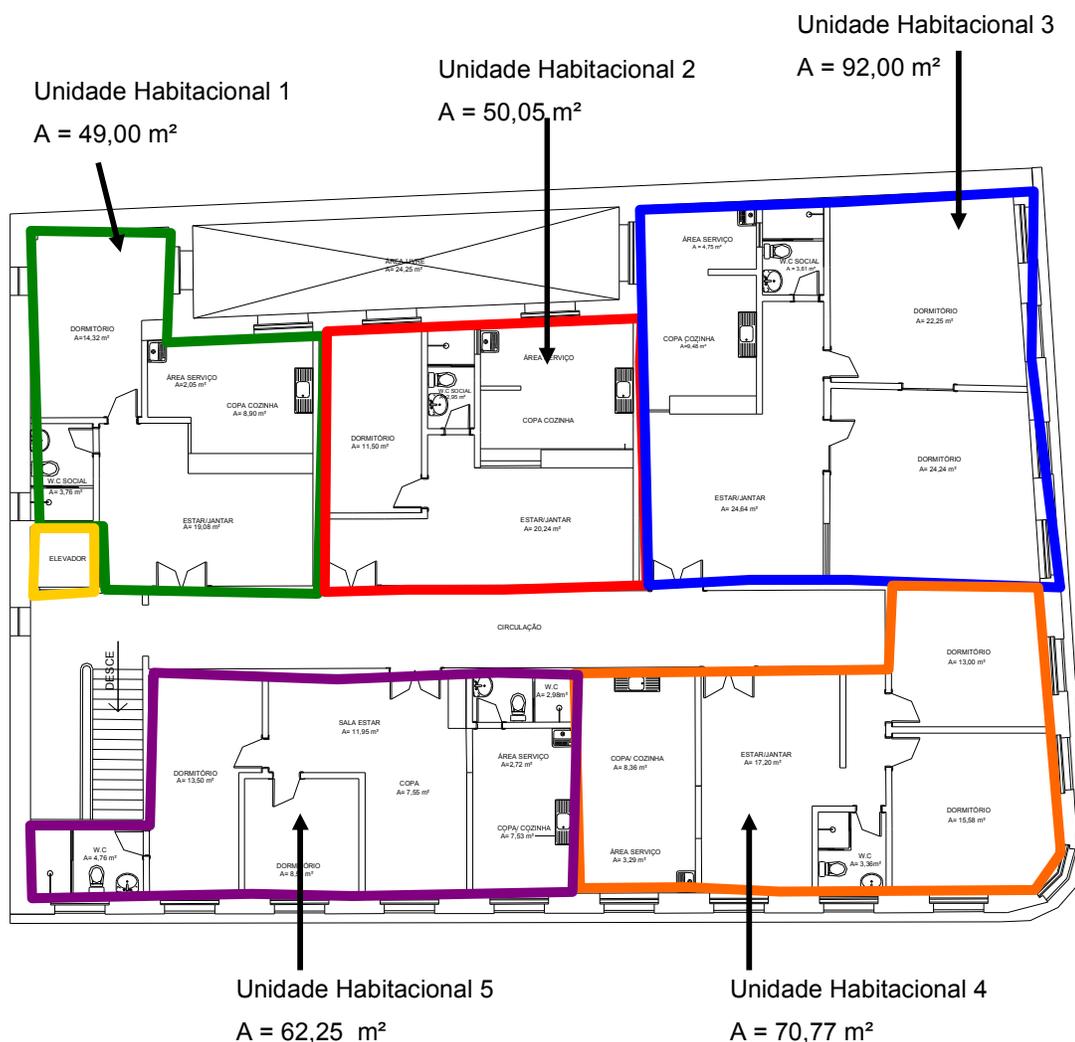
Planta baixa da proposta do 2º pavimento do imóvel da Trav. Leão XIII, Nº 55/Rua Santo Antônio 139/153.
